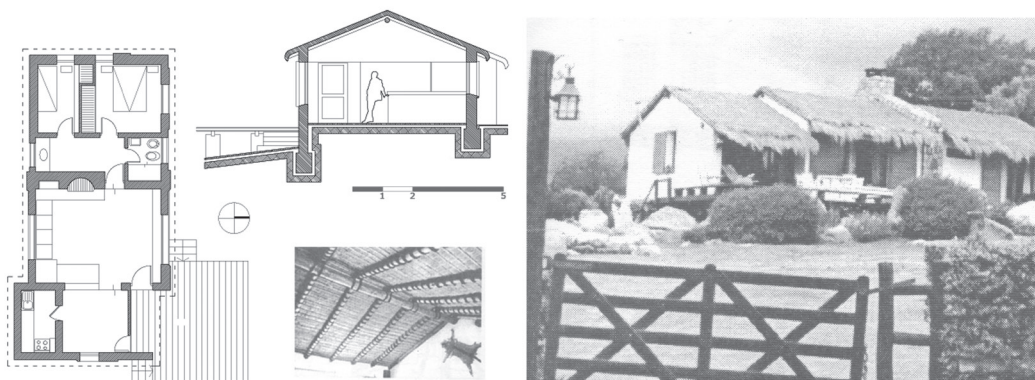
| Planta, corte transversal, detalle de techo y vista exterior, Casa Paz (Cosogliad, 2003:56-57)
